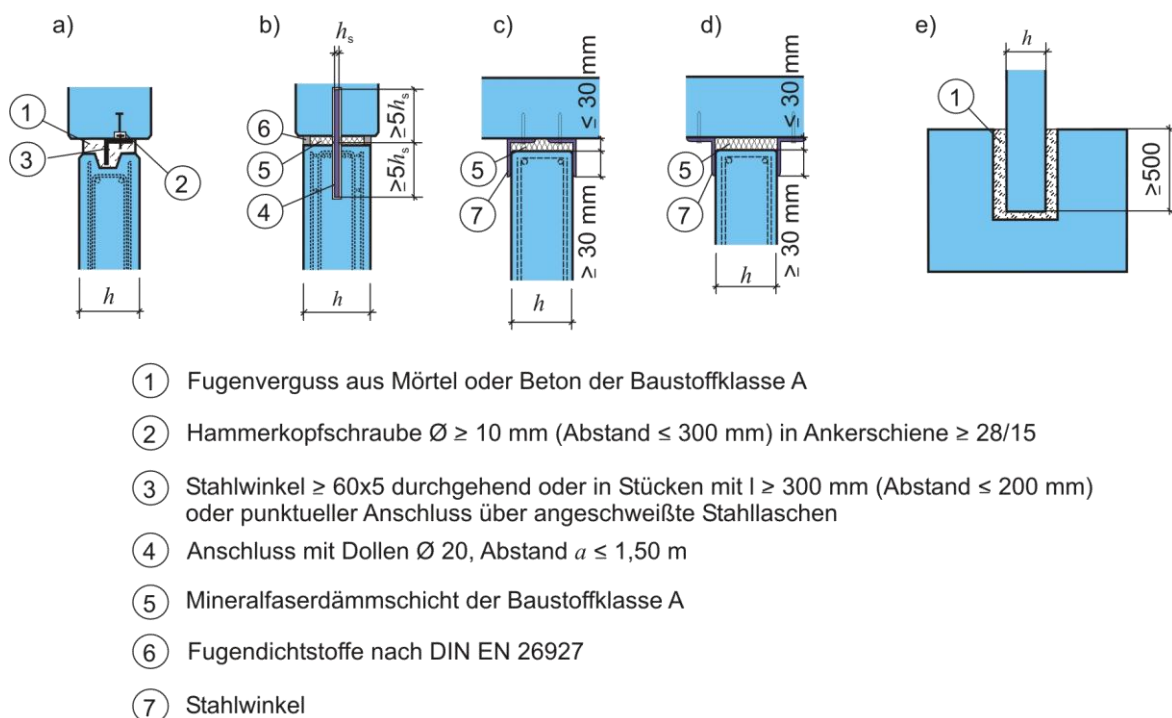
Beispiele für Anschlüsse von Fertigteil-Brandwänden, a) und b) an Stahlbetonriegel, c) und d) an Deckenplatten, e) Einspannung in Köcher- oder Schlitzfundamente
